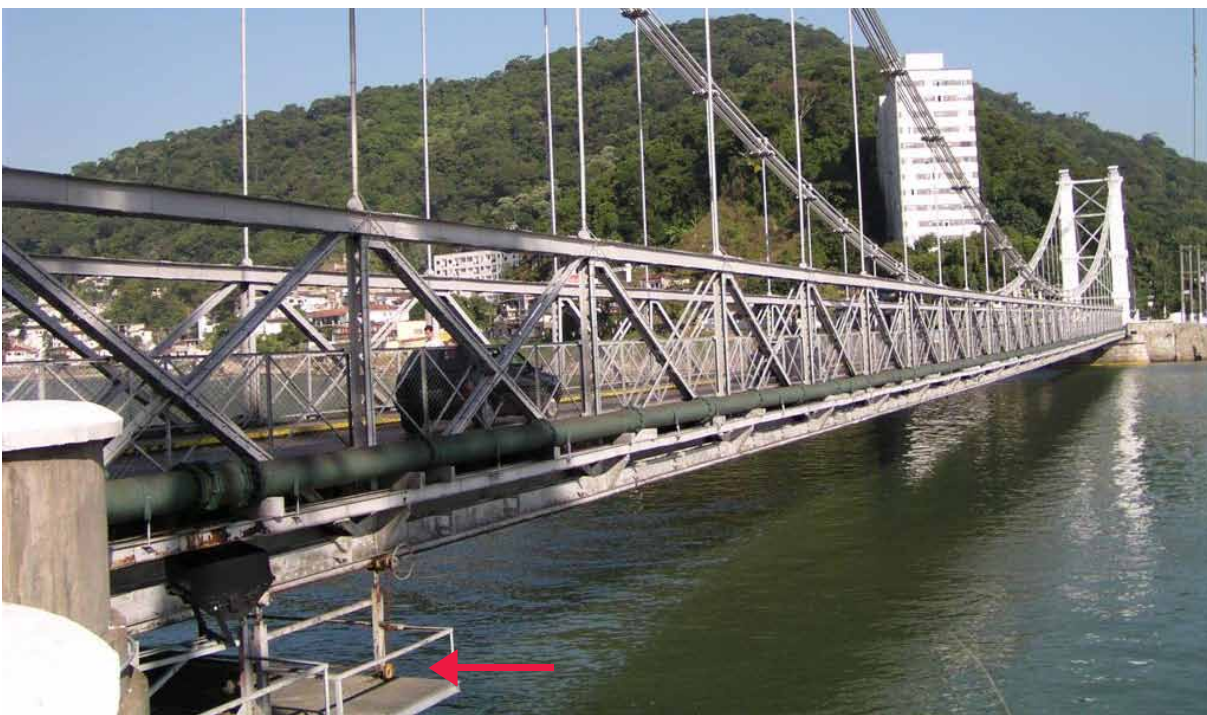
Outra vista da ponte. A seta indica a plataforma móvel para inspeção e manutenção, instalada sob a ponte.
